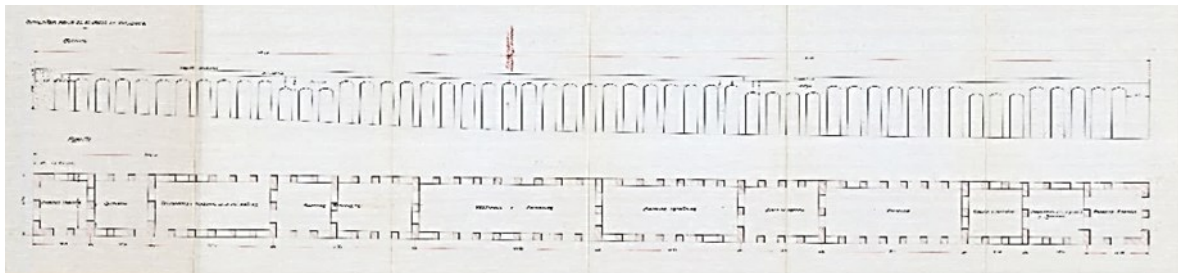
Alzado de los cimientos y planta con distribución de espacios para la planta baja según el Proyecto de cimentación del Edificio de servicio de Ramírez en 1919. Anexo IV.
